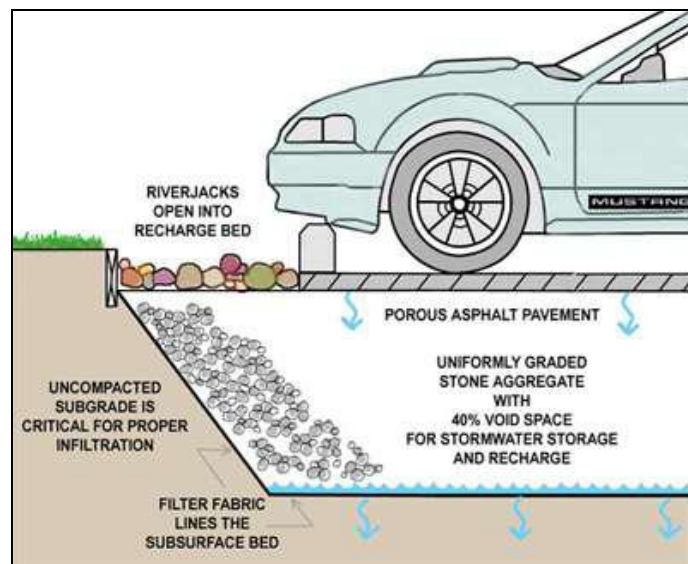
Funzionamento di un parcheggio con pavimentazione porosa [Pennsylvania Stormwater Management Manual]
